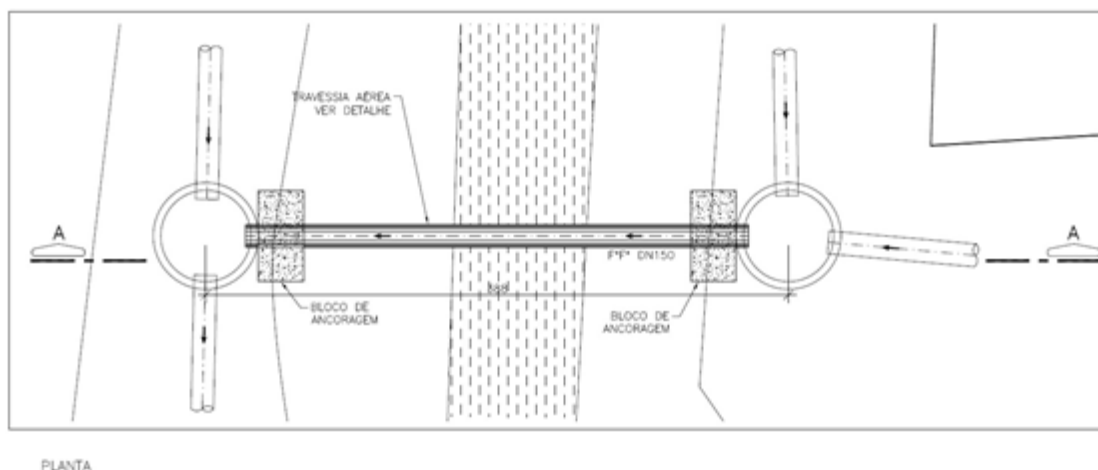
Planta baixa da travessia com indicações dos blocos de ancoragem.
